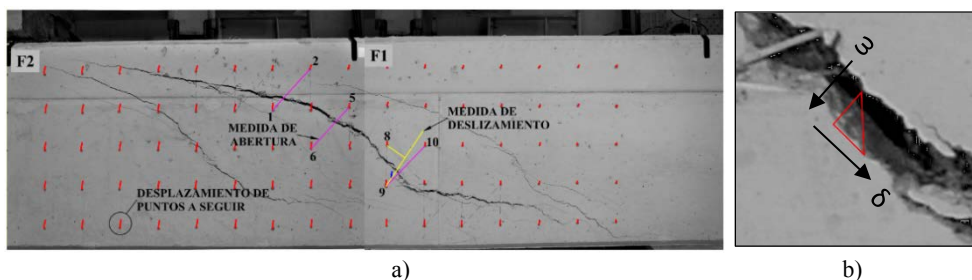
a) Medición entre puntos de seguimiento en fotografías posición F1 y F2 de viga 0AP1, b) Abertura y deslizamiento a carga máxima de fisura diagonal principal viga 0AP1
